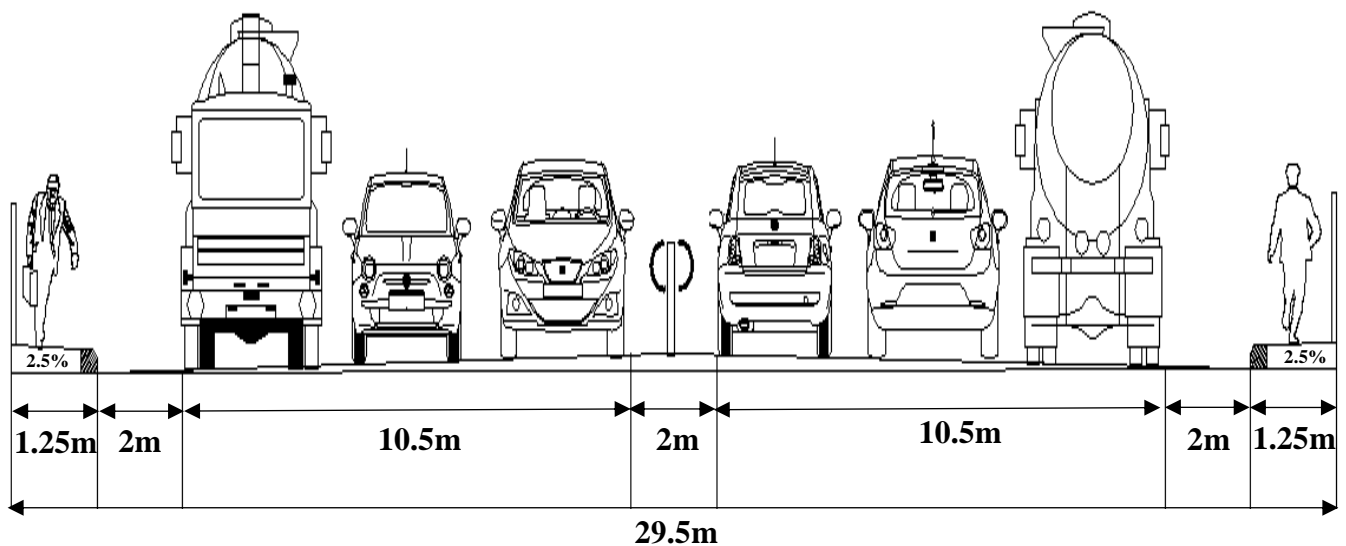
Profil en travers type au niveau de l'ouvrage d'art.
